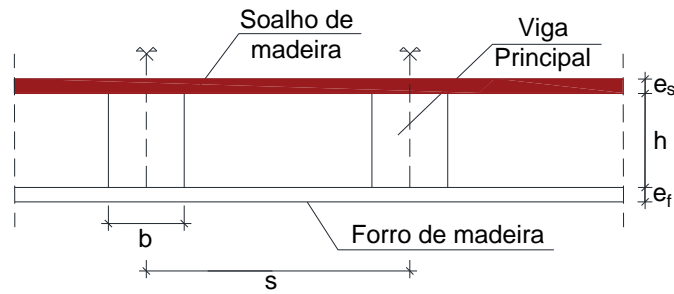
Secção média dos elementos de madeira que compõem o pavimento 1 (Pav. 1 – S1.1)
